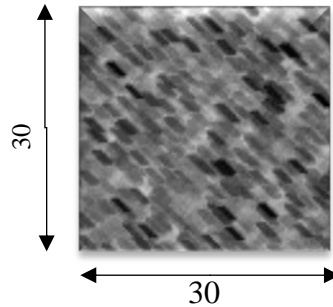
Section transversale de la poutre $30 \times 30 \text{ cm}^2$.
